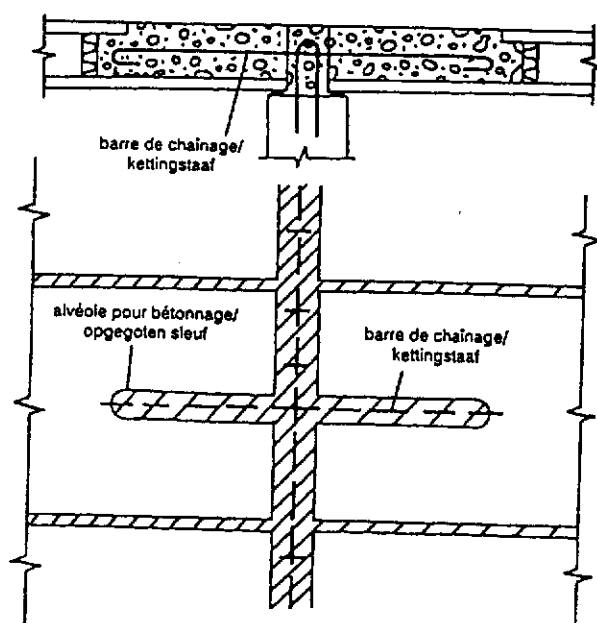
Dispositions constructives : armatures et béton coulé dans les joints
